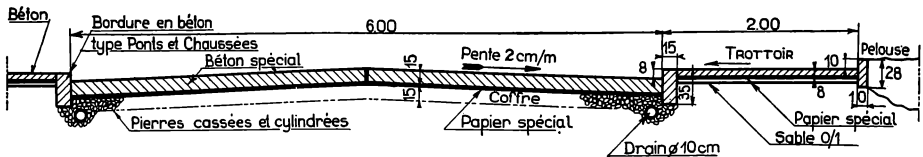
Coupe transversale de la route en béton et des trottoirs.
